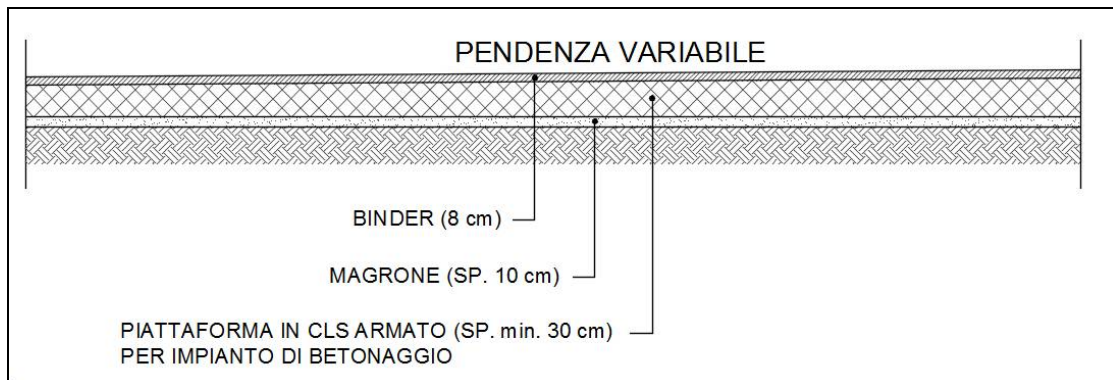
Schematizzazione delle tipologie di materiale impiegate per la realizzazione delle pavimentazioni bitumate l'alloggiamento degli impianti di betonaggio.
